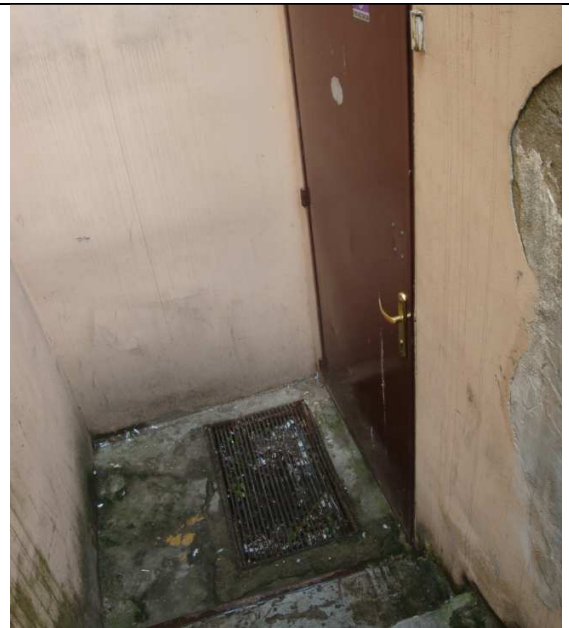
Widok schodów zejściowych do piwnicy. Stan zniszczenia wszystkich stopni identyczny, warstwa zabezpieczająca stopnie betonowe w znacznej części uległa detrukcji.
